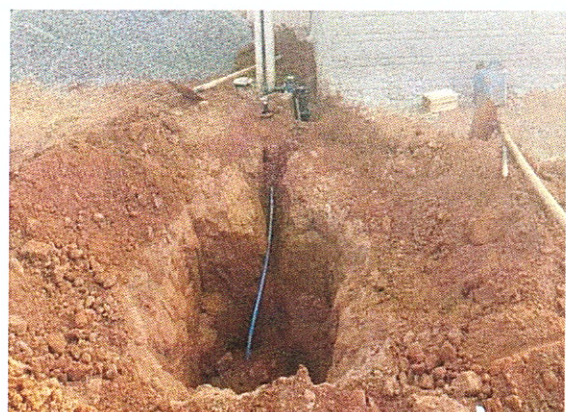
Implantação de nova ligação de água – Avenida Perimetral
